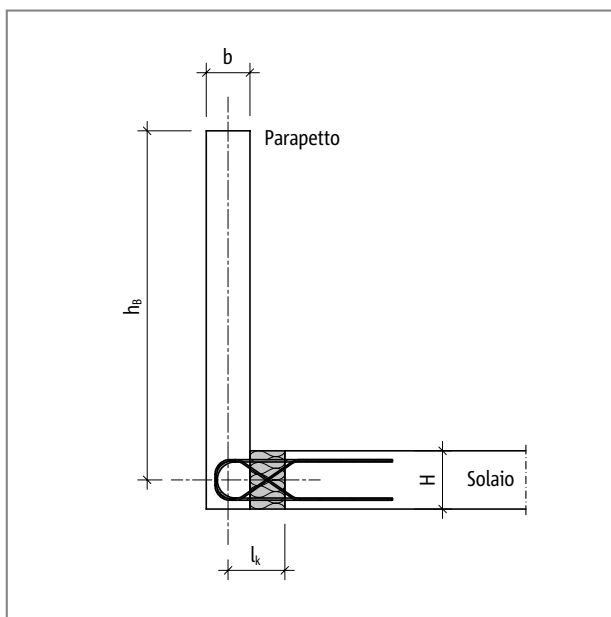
Schöck Isokorb® tipo ABXT: schema statico con altezza del parapetto h_B
